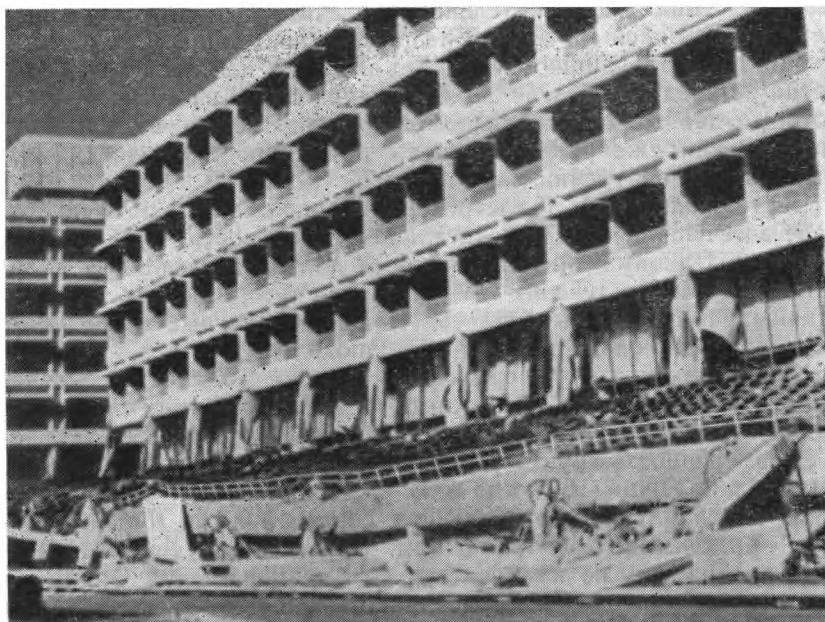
Разрушение железобетонных колонн нового здания больницы Олив-Вью при Калифорнийском землетрясении 9 февраля 1971 г. (фото Б. Болта).
